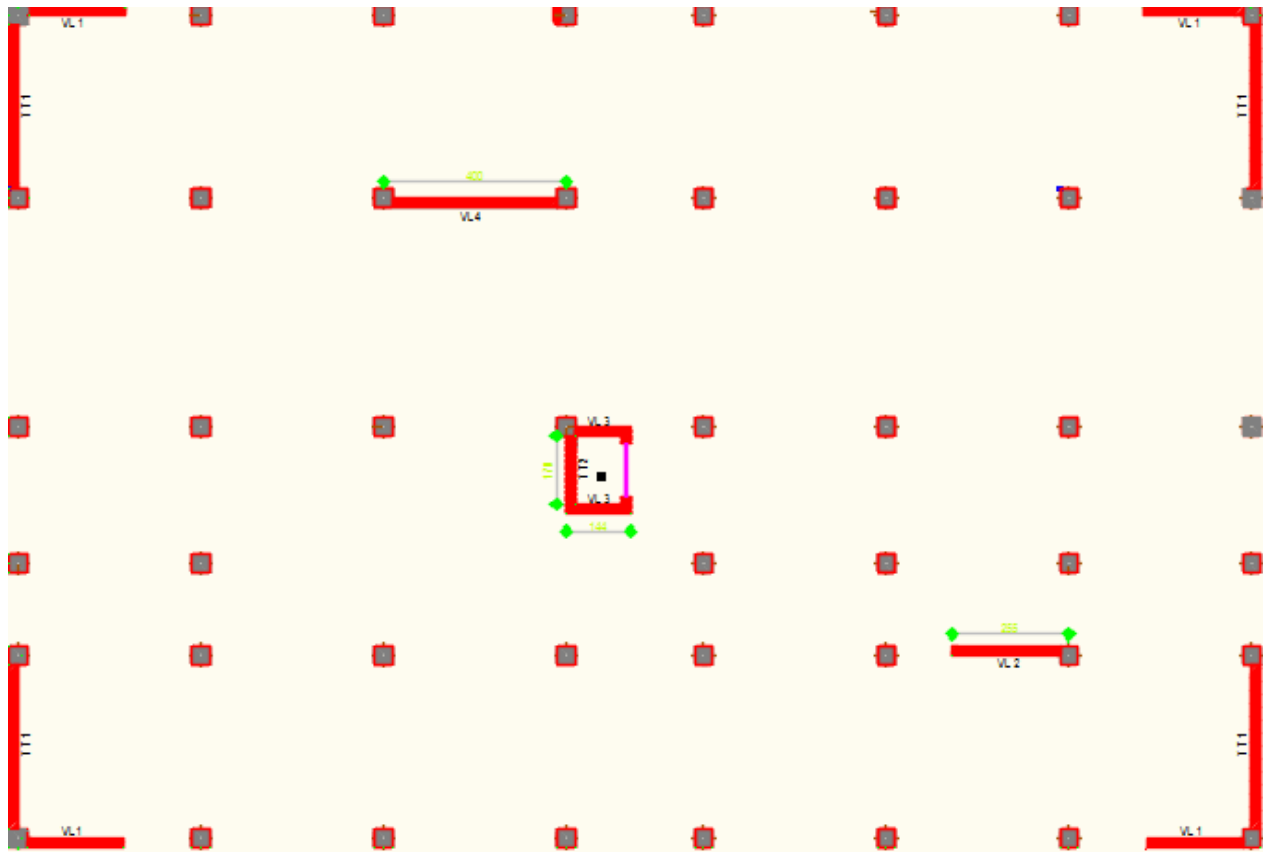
Schéma de la disposition des poteaux et des voiles du RDC
